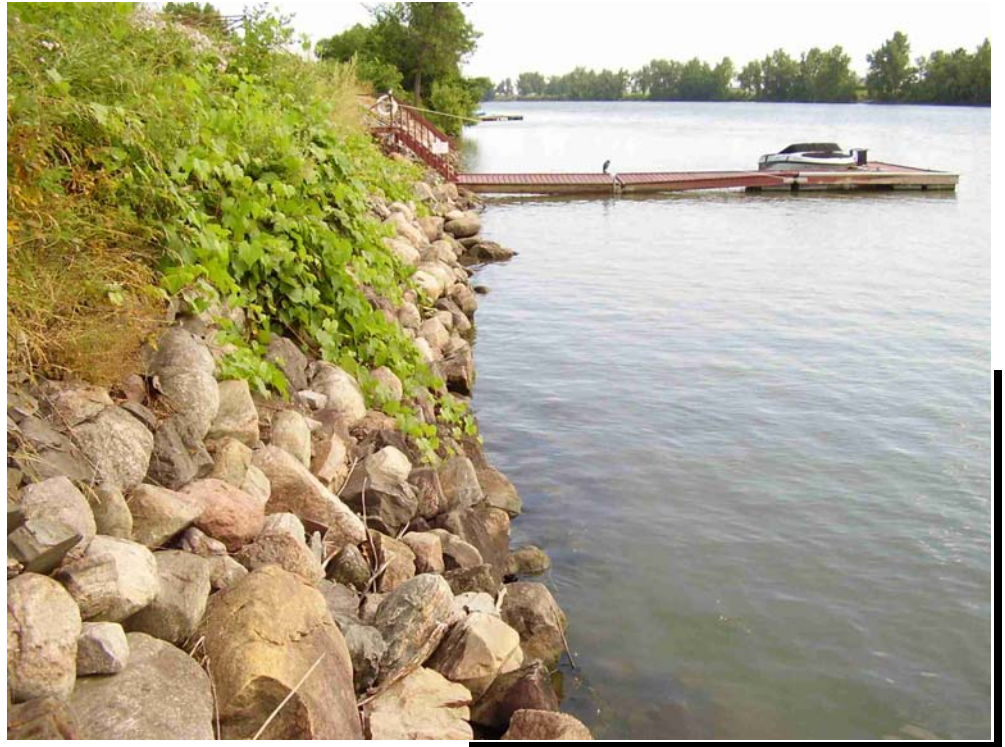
Site 19 – Saint-Marc-sur-Richelieu
